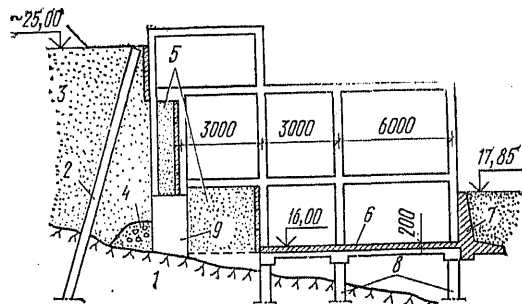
Усиление подземной части здания, возведенного на оползневом склоне
